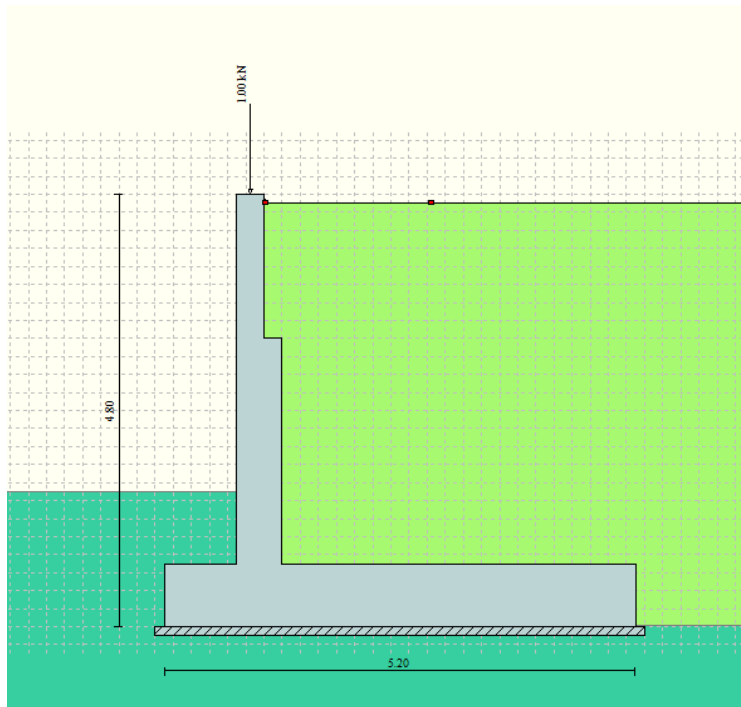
Applicazione dei carichi: Peso parapetto
